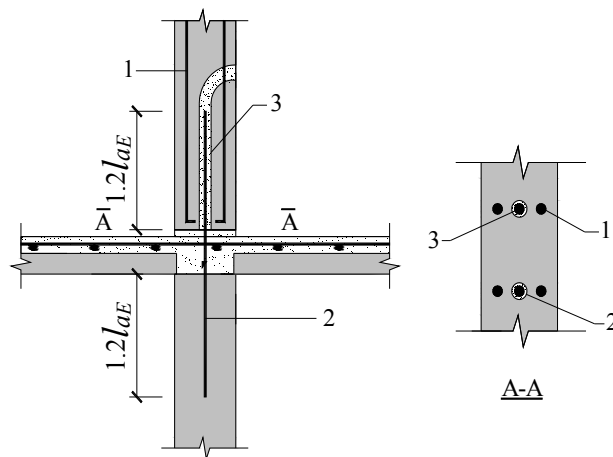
竖向分布钢筋金属波纹管浆锚搭接连接单排连接构造示意
